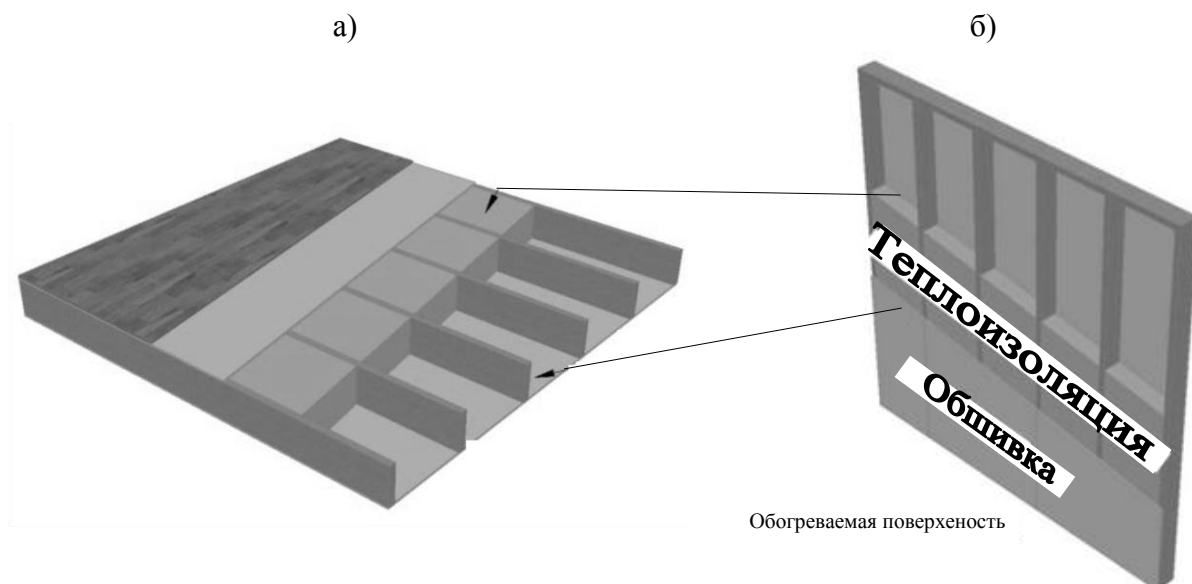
Каркасные элементы: а - перекрытие; б - стена
